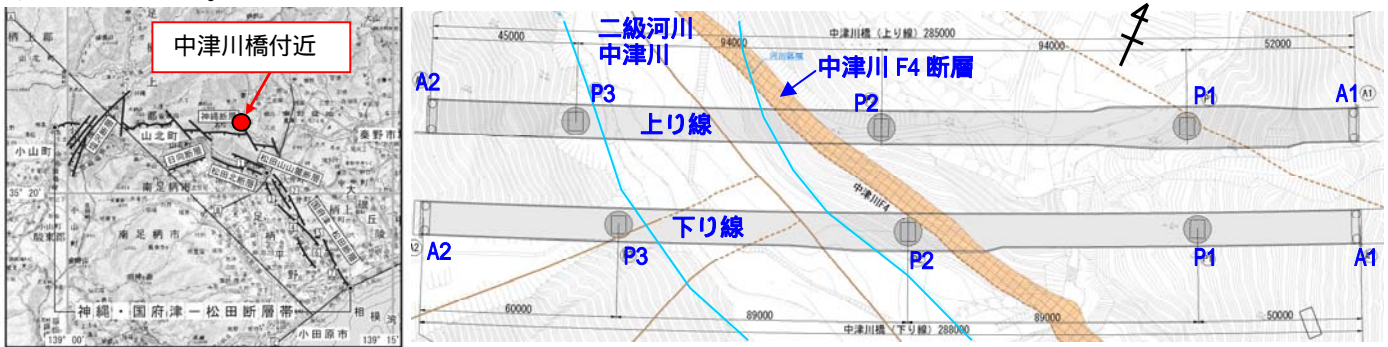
断層位置図<sup>1)</sup>と当初計画平面図
